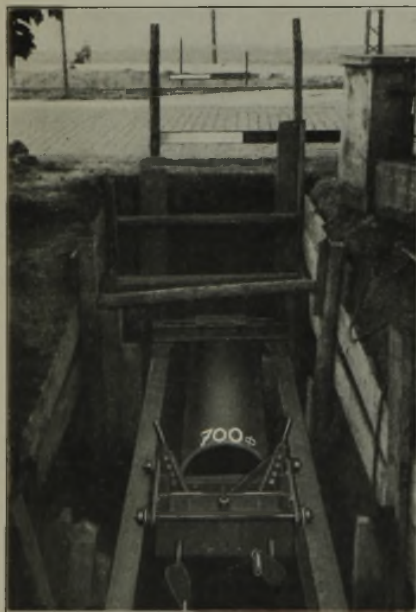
Durchdrücken unter Straßen und Eisenbahngleisen.
